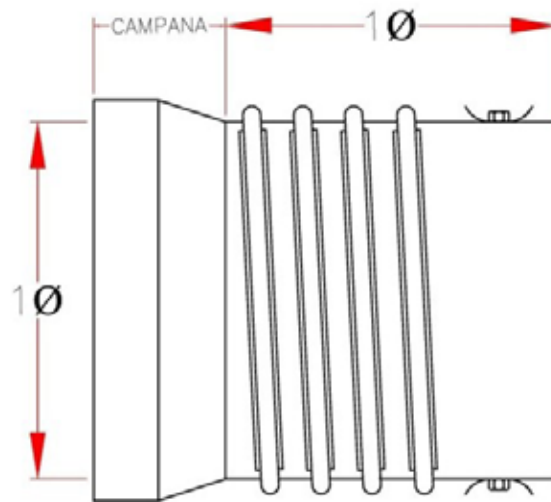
Manguito conector a Cámara Hormigón-Campana
